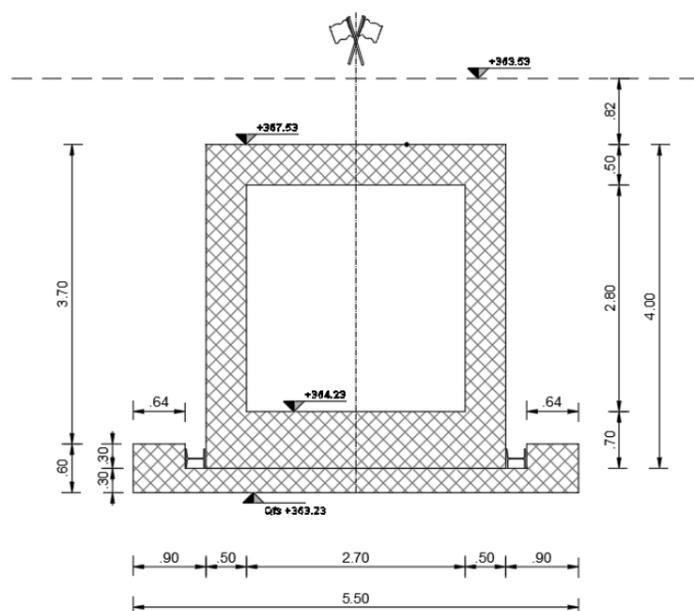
Sezione scatolare del tombino di attraversamento della ferrovia
